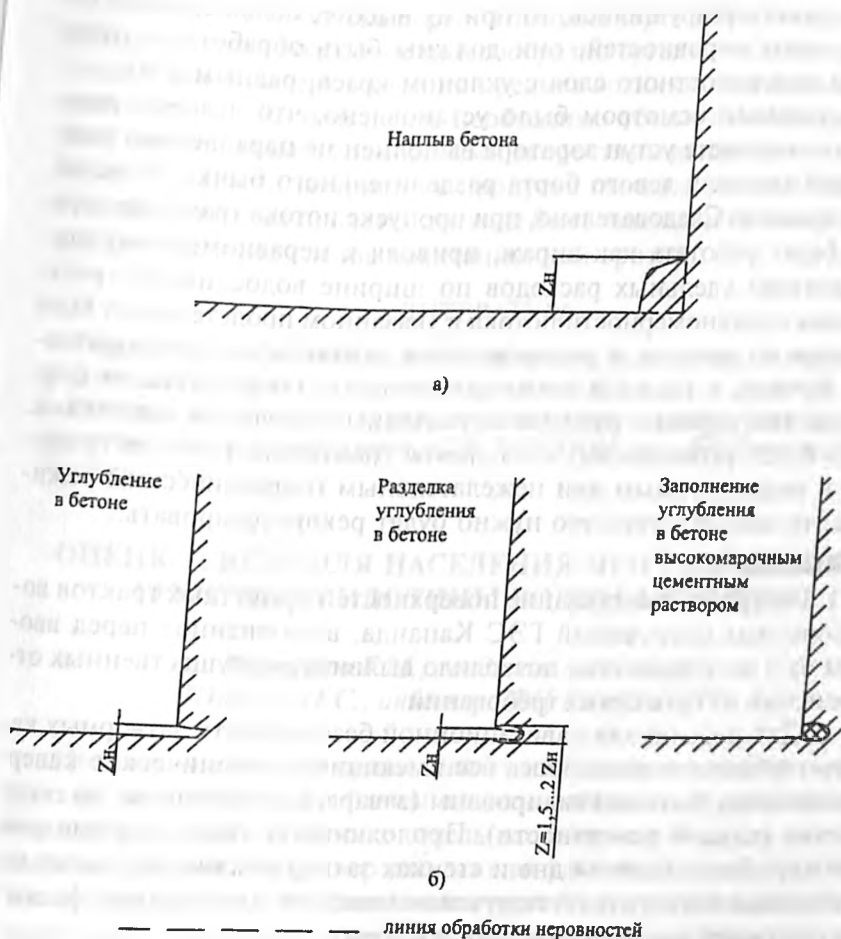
Схема обработки неровностей в месте сопряжения водосливной грани и боковых стенок разделительных бычков: при наличии наплыва бетона (а) и углубления в бетоне (б)
